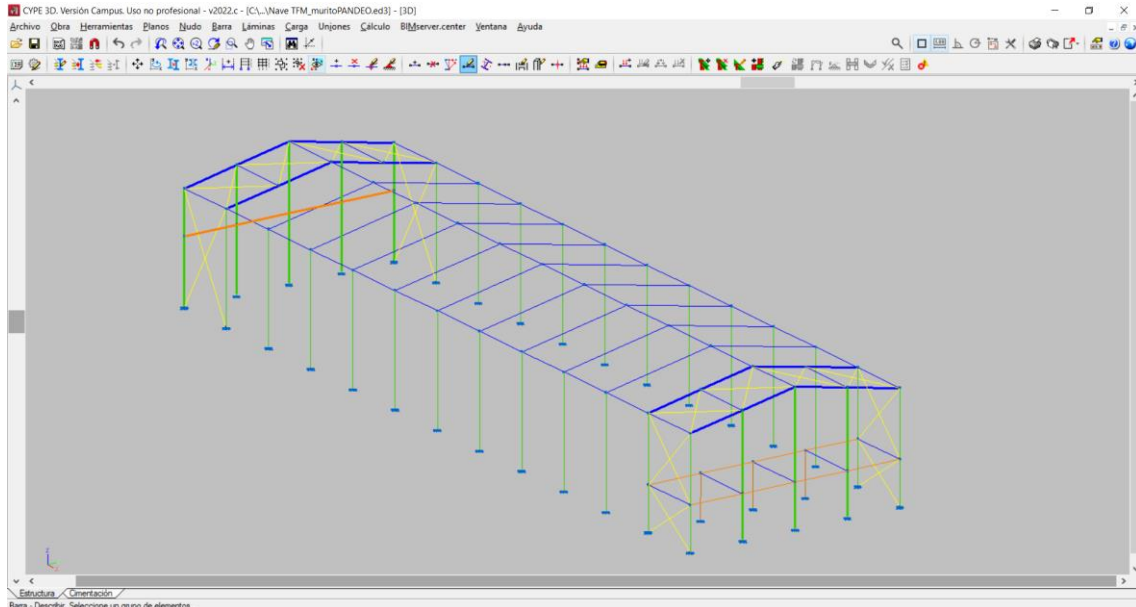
18 Barras de grupo 7 - Vigas transversales 1ª planta indicados en naranja
